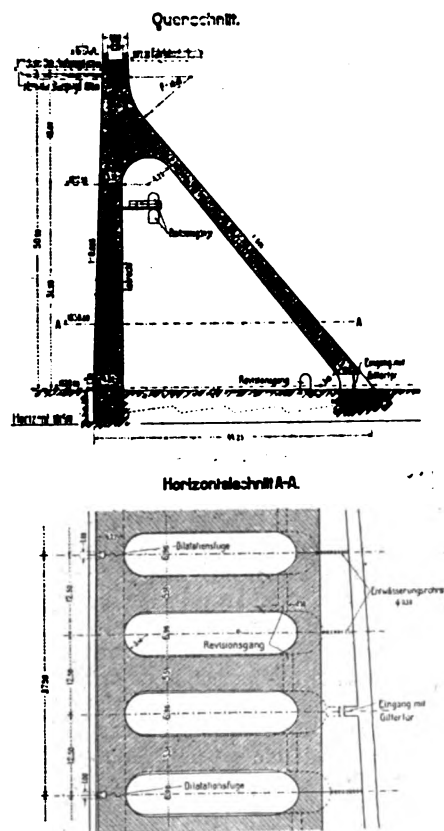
Sections verticale et horizontale du barrage de Gelmer. Echelle 1:1000.
